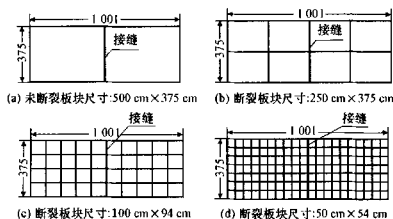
旧水泥混凝土路面板断裂尺寸平面图(单位:cm)
